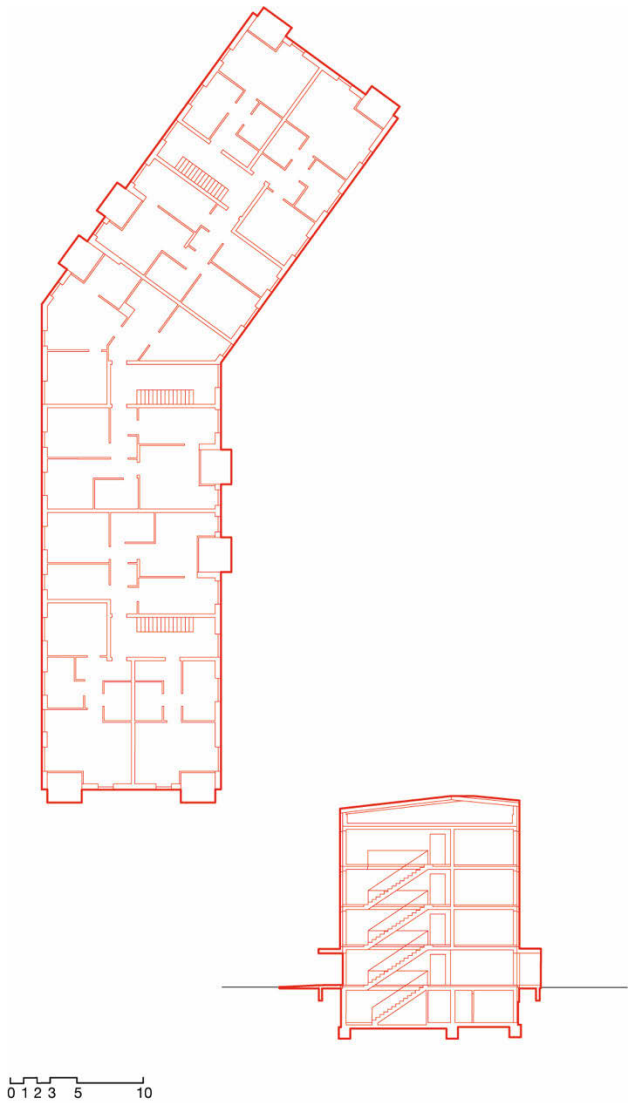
Grundriss – Schnitt, Ersatzneubau, Buchheimer Weg
